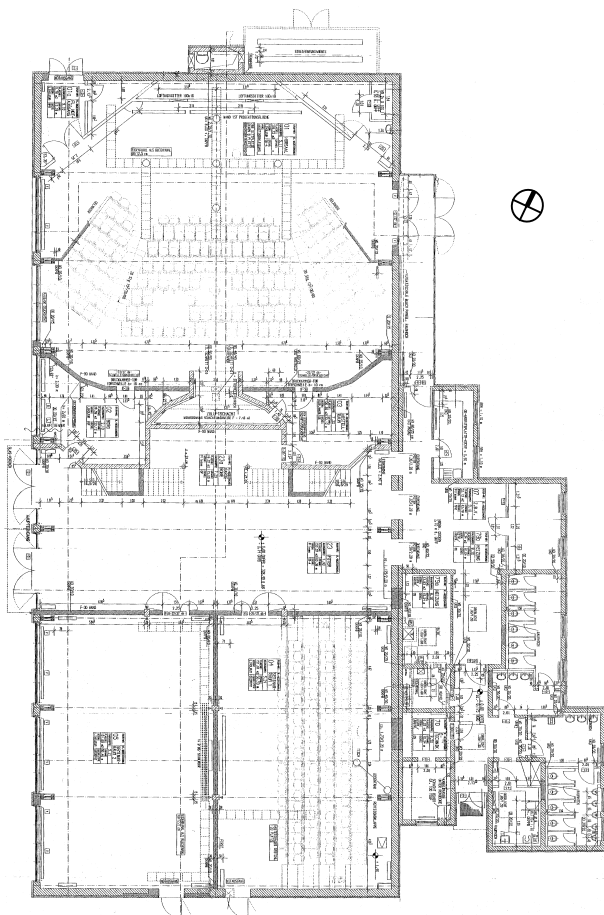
Grundriss (Maßstab ca. 1:400)
